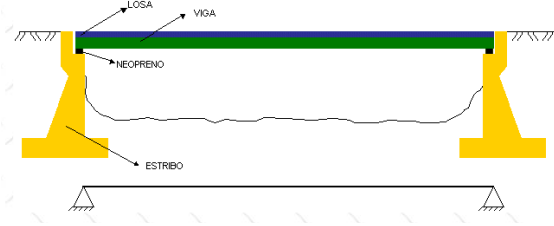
Puente de vigas isostático en un tramo
